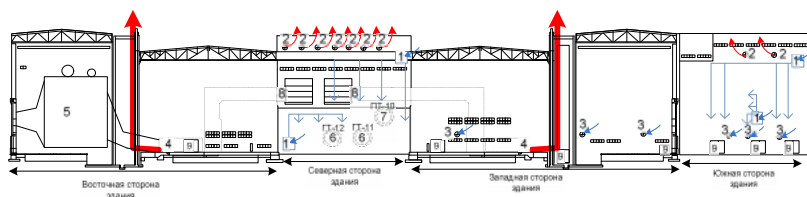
Развертка главного корпуса ПГУ-325: 1 – вентиляционный блок (ВБ); 2 – вытяжной вентилятор; 3 – приточный вентилятор; 4 – тепловое укрытие ГТД; 5 – котел-утилизатор (КУ); 6 – газовая турбина (ГТ); 7 – паровая турбина (ПТ); 8 – комплексное воздухоочистительное устройство (КВОУ); 9 – ворота главного корпуса; ТД – труба дымовая; БЩУ – блочный щит управления; стрелками показано движение приточно-вытяжного воздуха
